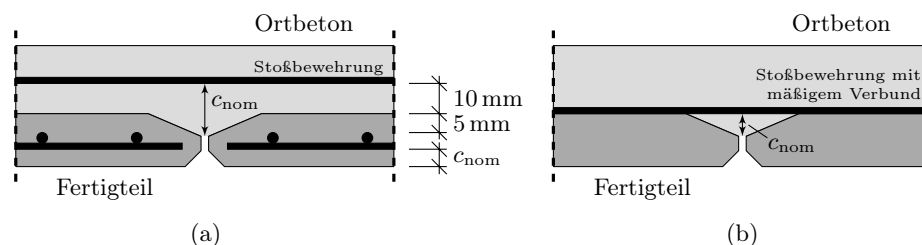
Betondeckung bei mit Ortbeton ergänzten Elementdecken
